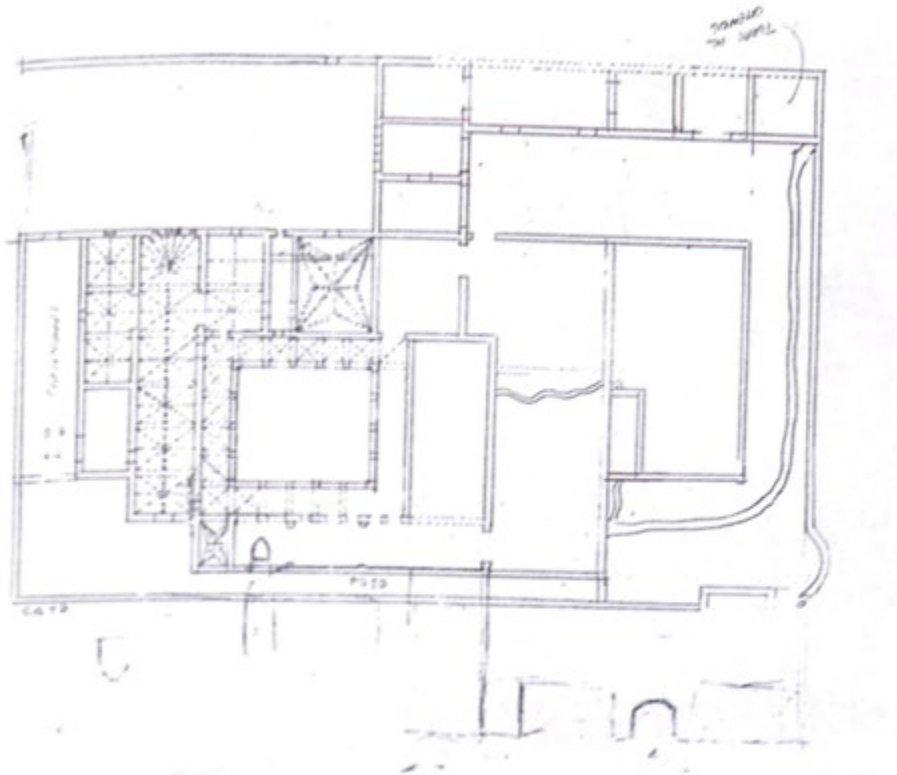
Rioseco, Santa María, Grundriss Kirche und Kloster, Cardñanos Bardeci, 2004.
